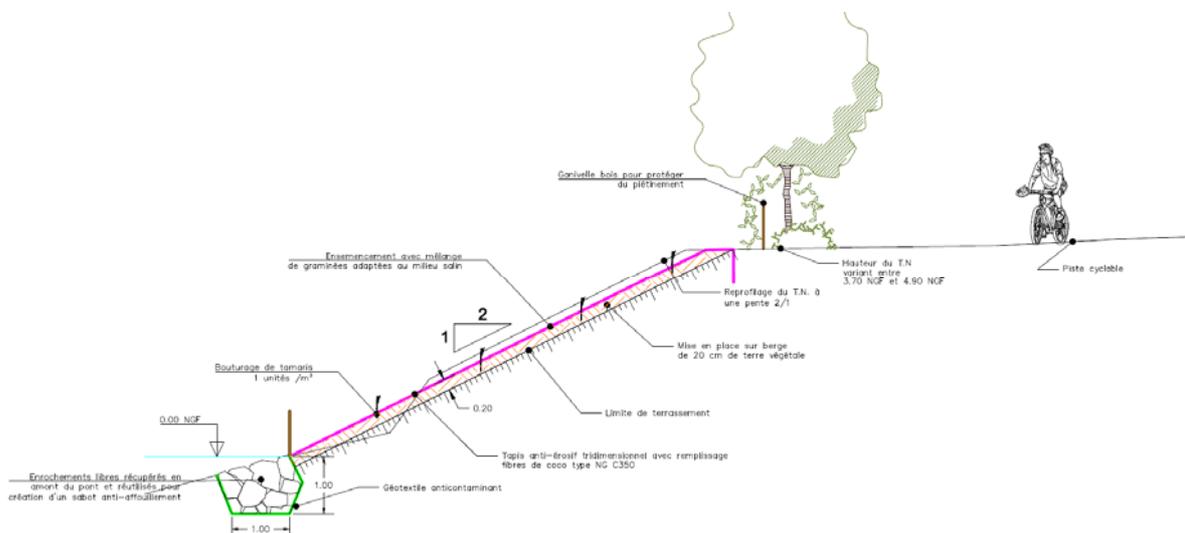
Exemple de coupe en travers type du reprofilage des berges (SCE)
